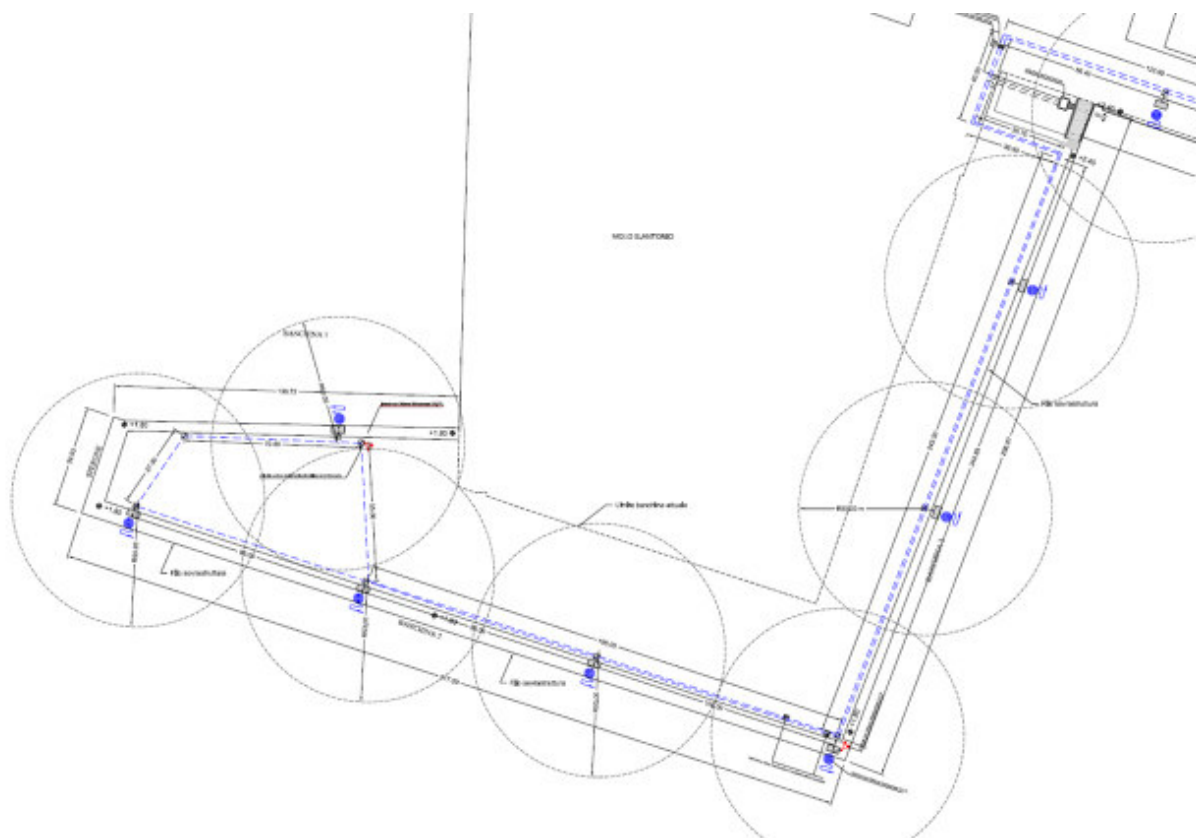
Stralcio planimetria EEG06006T2302 – Banchina 2 e 3
